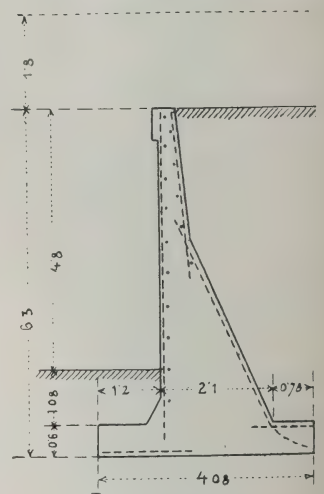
Querschnitt einer amerikanischen Eisenbetonstützmauer.
